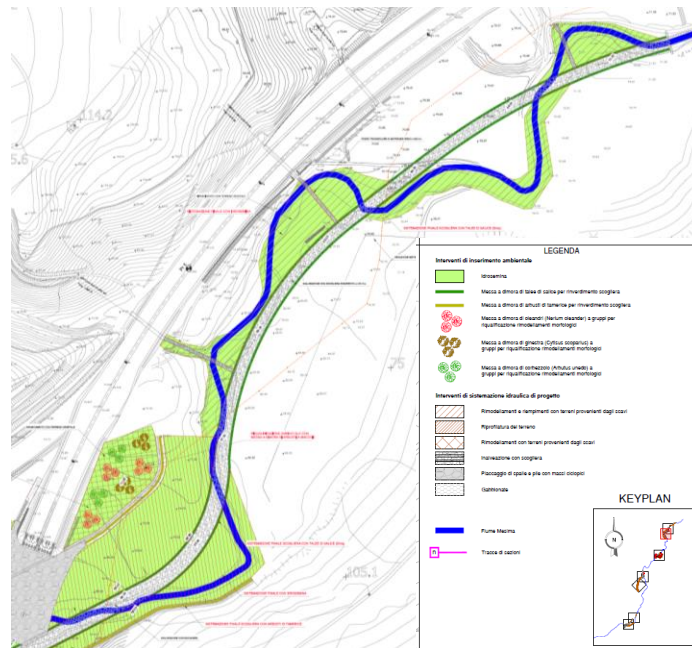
Planimetria interventi di progetto – tratto a monte viadotto Mesima 1
